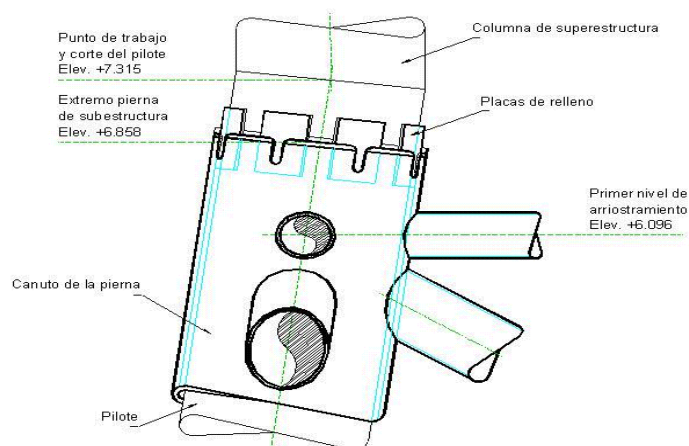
La conexión de la Subestructura-Pilote-Superestructura.
